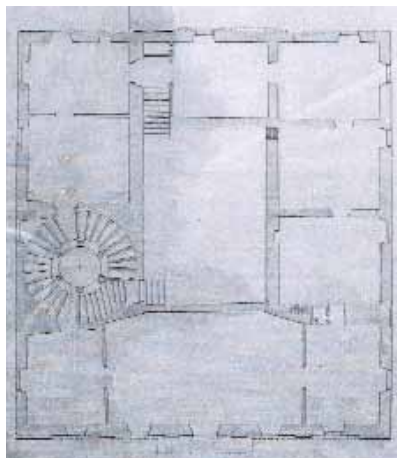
Rilievo di Giuseppe Mazzuoli precedente il 1690. Pianta del secondo piano. Si osservi l'inclinazione del muro a destra e sinistra della loggia di facciata: traccia dei precedenti bastioni di facciata. Bibl. Com. di Siena, ms. S. II, 7, c. 52.
